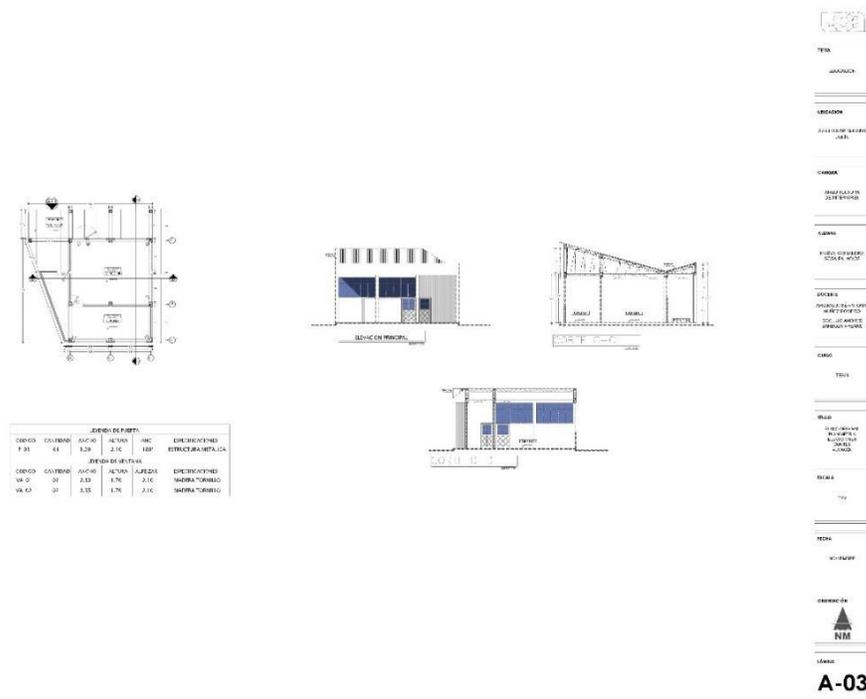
Planimetría Existente de la Municipalidad de San Luis de Shuaro. Fuente: Maeva Sosa
